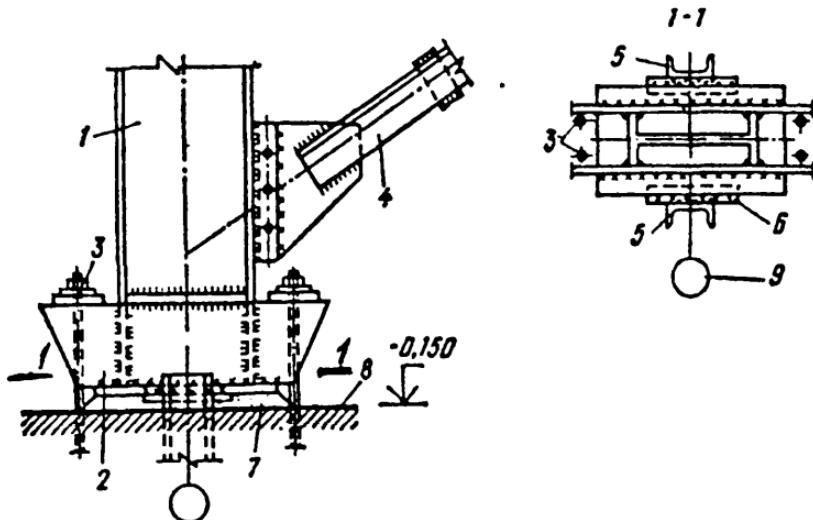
Узел опирания на фундамент ветви связевой колонны одноэтажного производственного здания:
